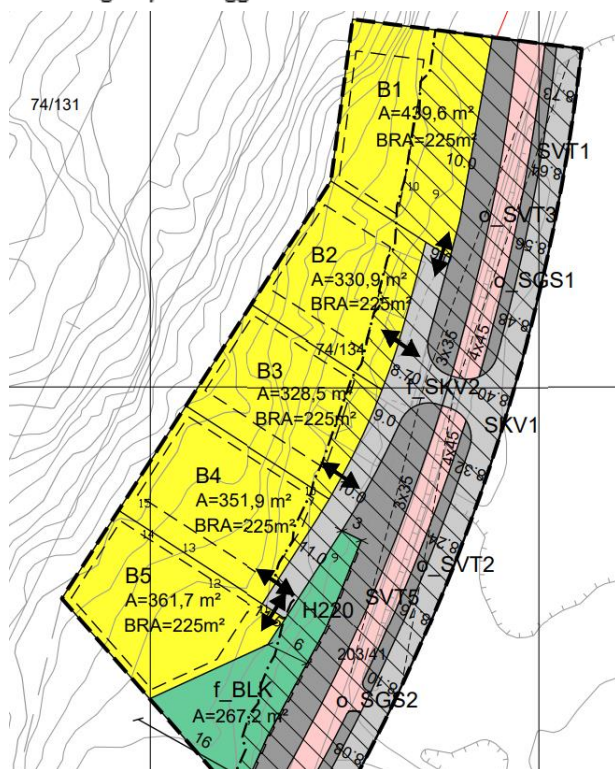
Planlagt lekeplass med 1,3 m høy støyskjerm.
